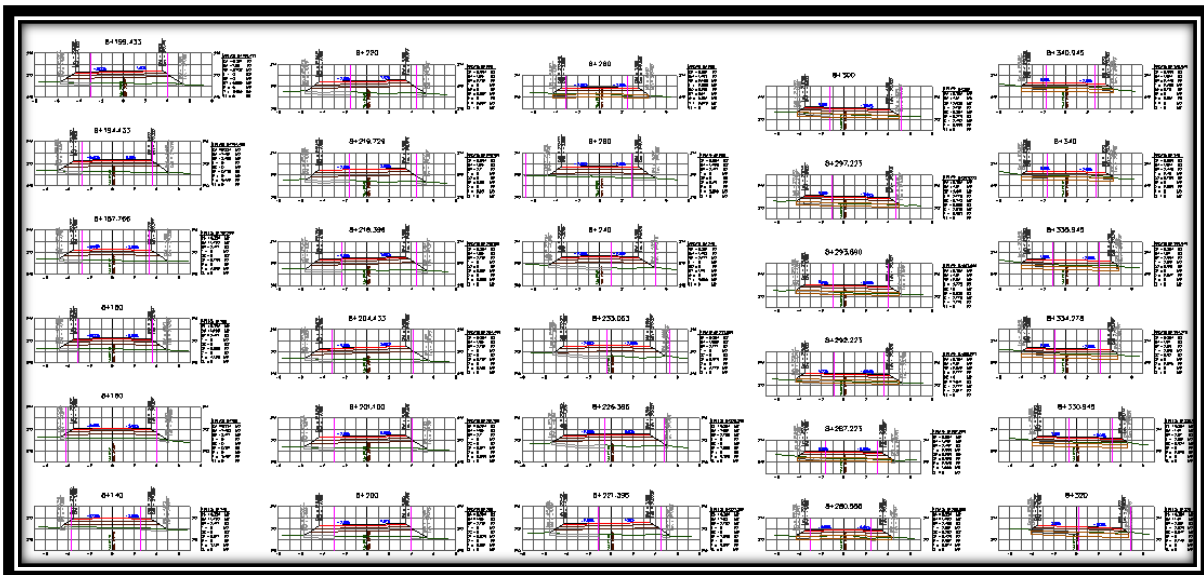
Secciones de construcción del km 8+140.000 al km 8+340.945.
